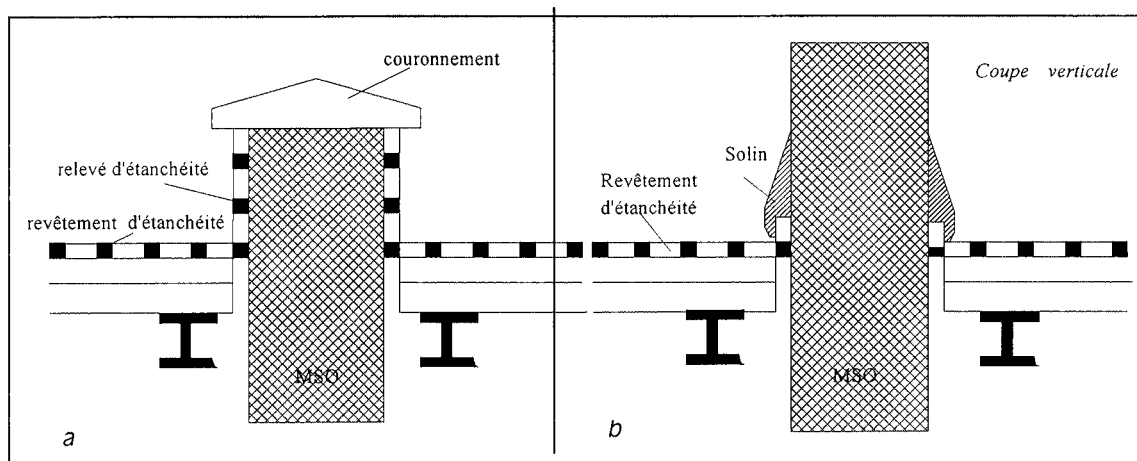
a et b. : Disposition du revêtement d'étanchéité.
